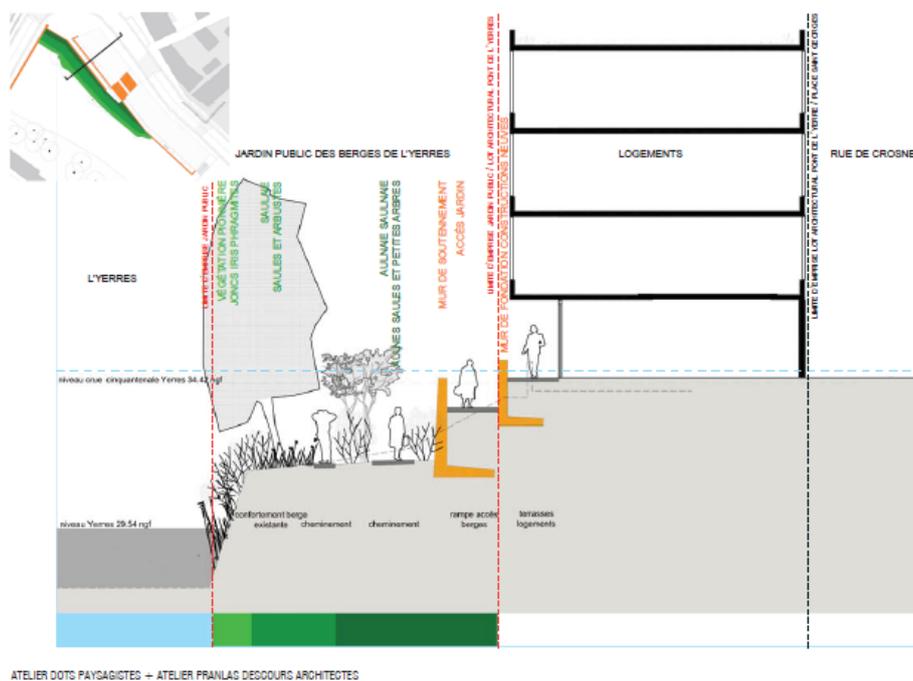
Coupe transversale de principe : Ouvrages et Plantations
